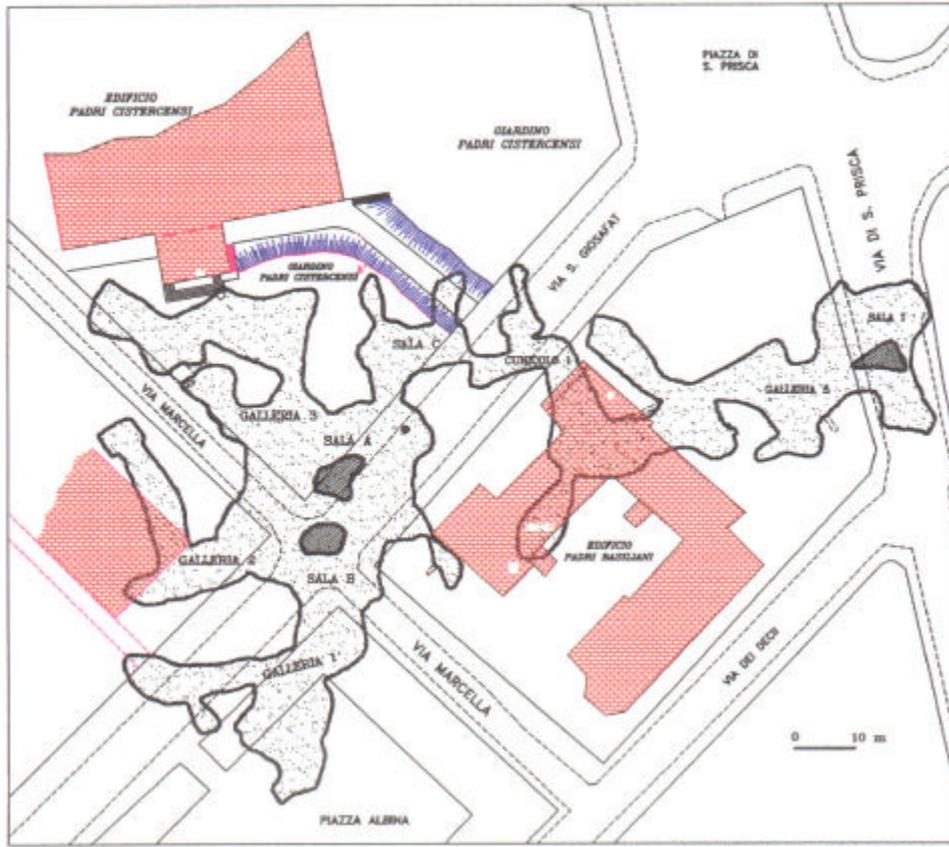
PLANIMETRIA DEL SISTEMA DI CAVITA'
